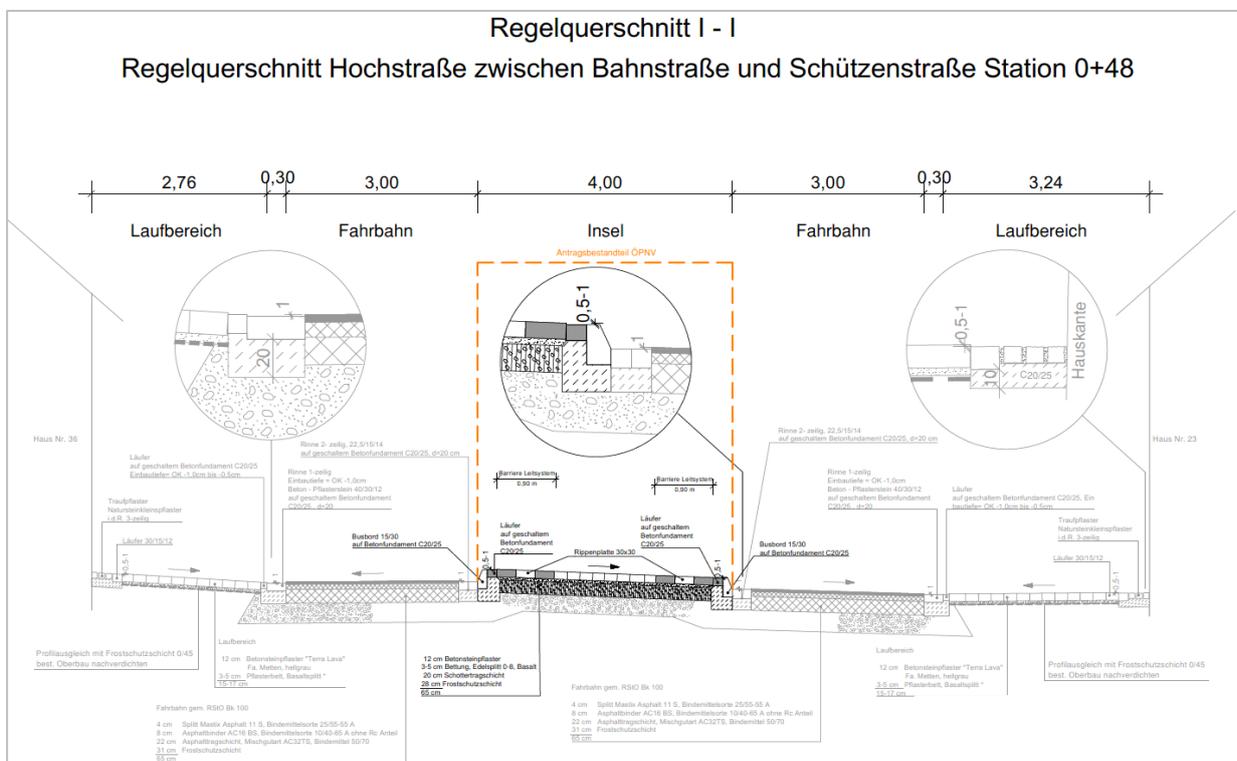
Planausschnitt Regelquerschnitt zentralen ÖPNV-Haltepunktes „Hochstraße“
